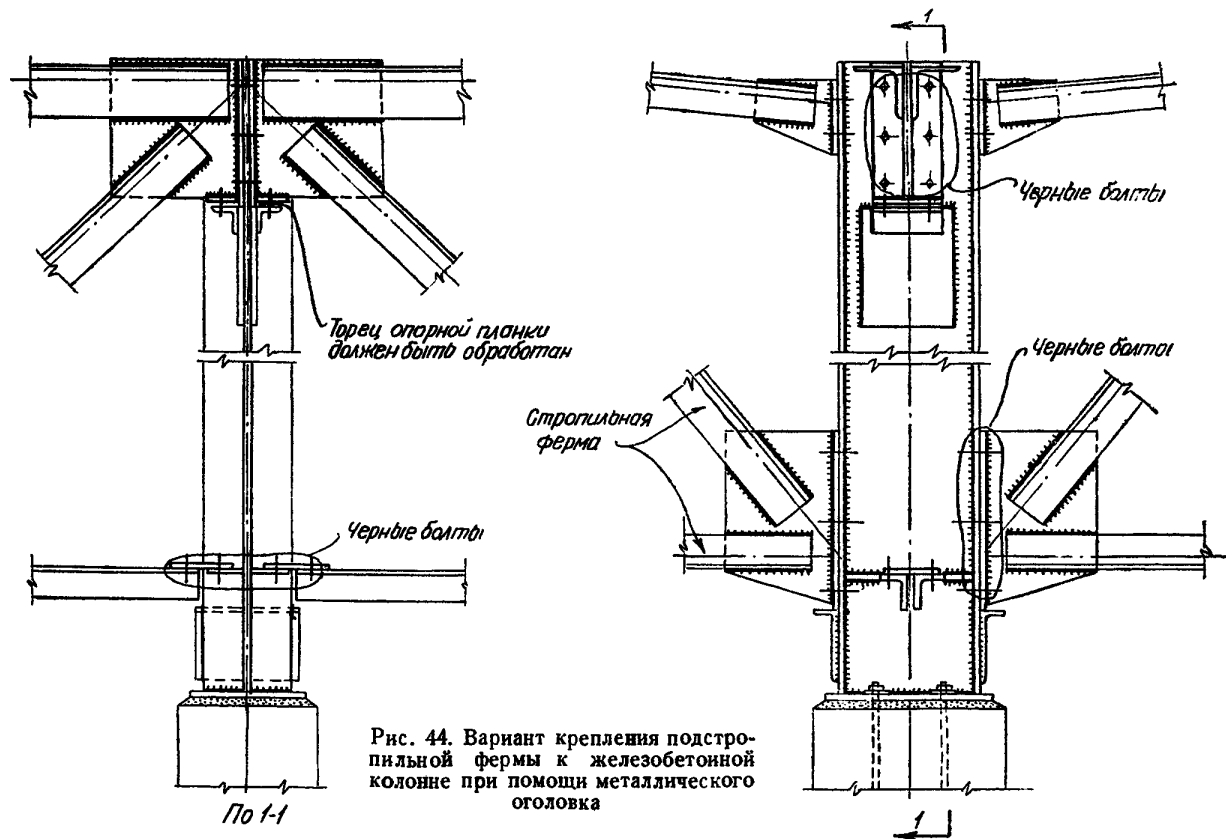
Вариант крепления подстропильной фермы к железобетонной колонне при помощи металлического оголовка
